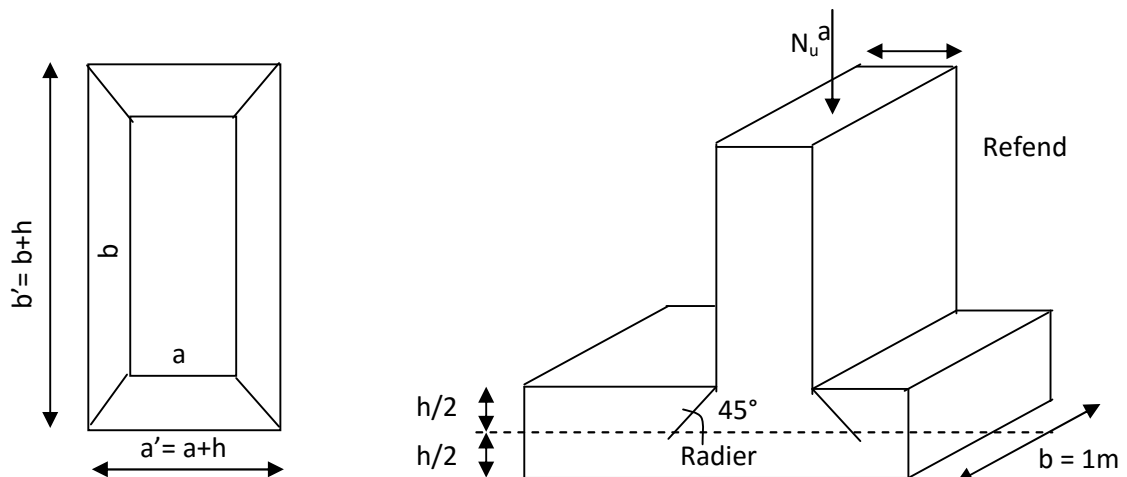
Périmètre utile des voiles et des poteaux.
